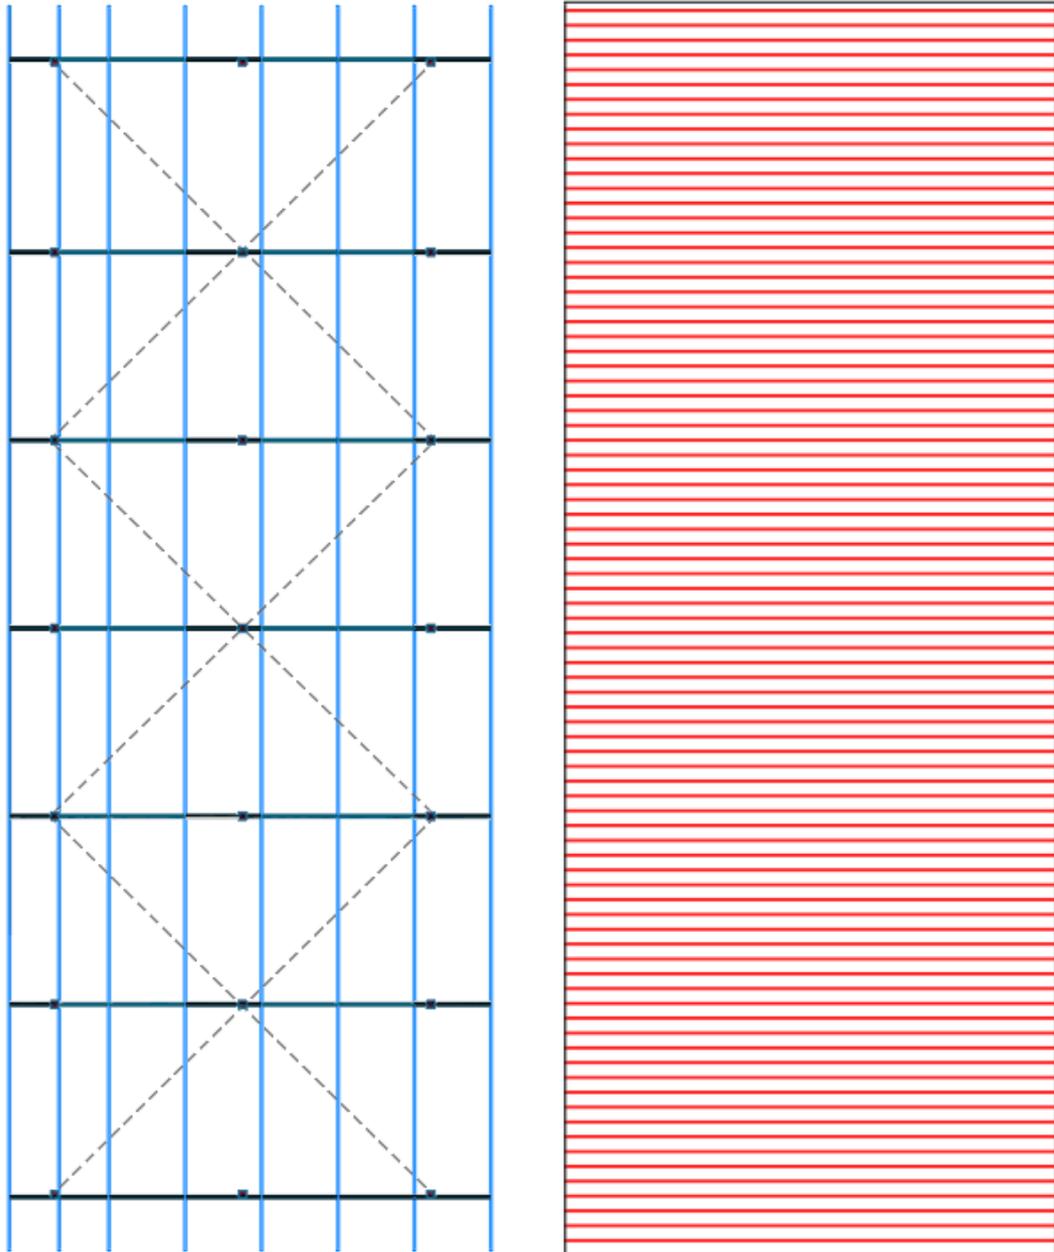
Plano en planta - Anclajes, Columnas, Vigas y Escaleras
